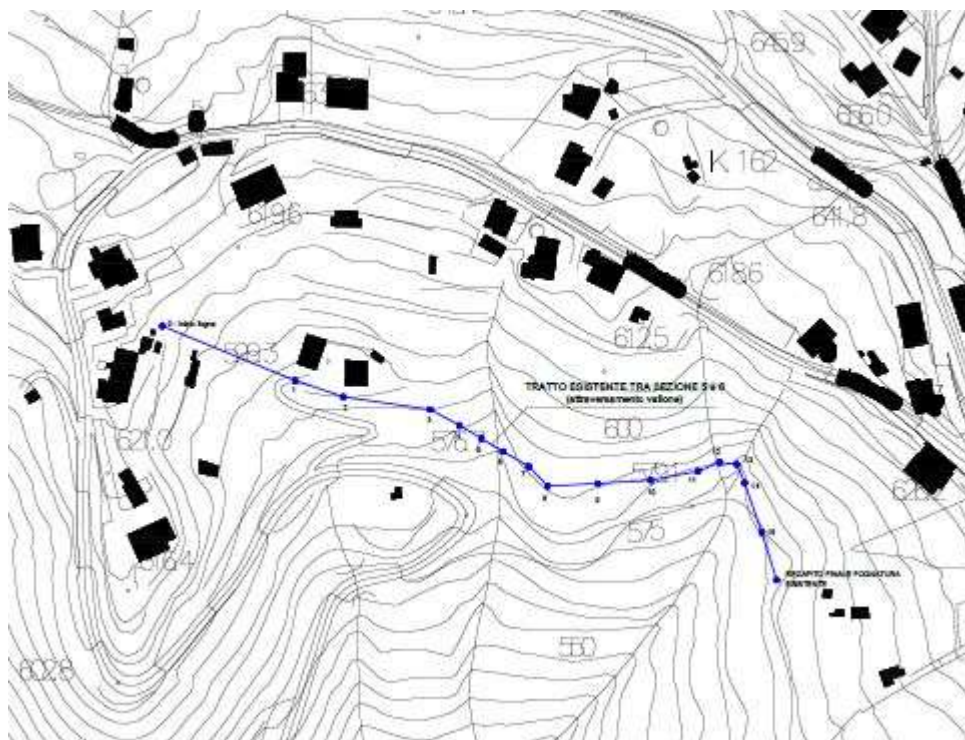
Stralcio della planimetria della rete fognaria esistente e di progetto
